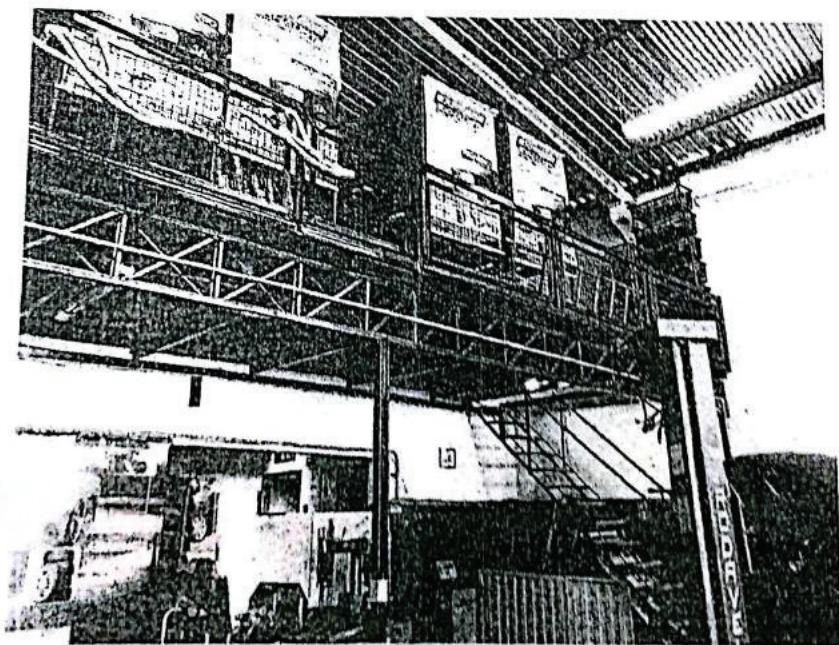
VISTA INTERNA - DETALHE MEZANINO FUNDOS IMÓVEL 01
